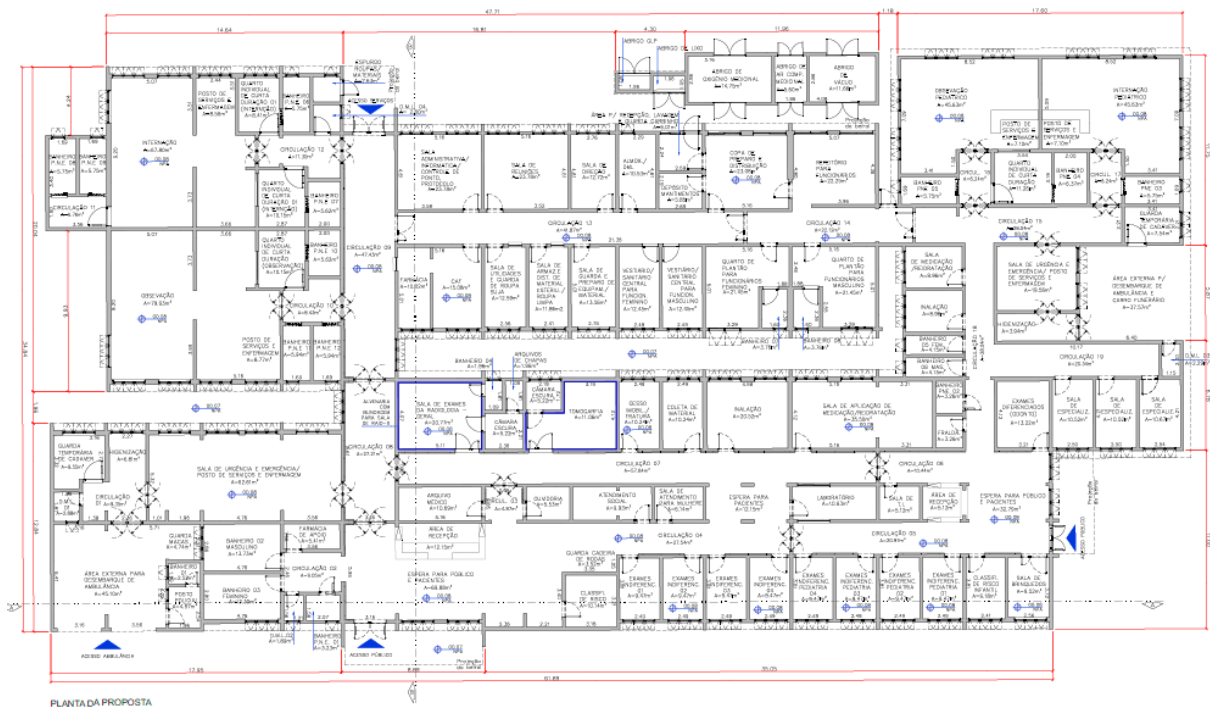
Planta baixa da proposta de ampliação da unidade de saúde.
